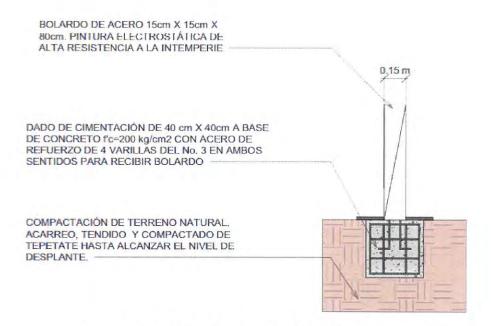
Detalle de bolardo considerado en el proyecto.
